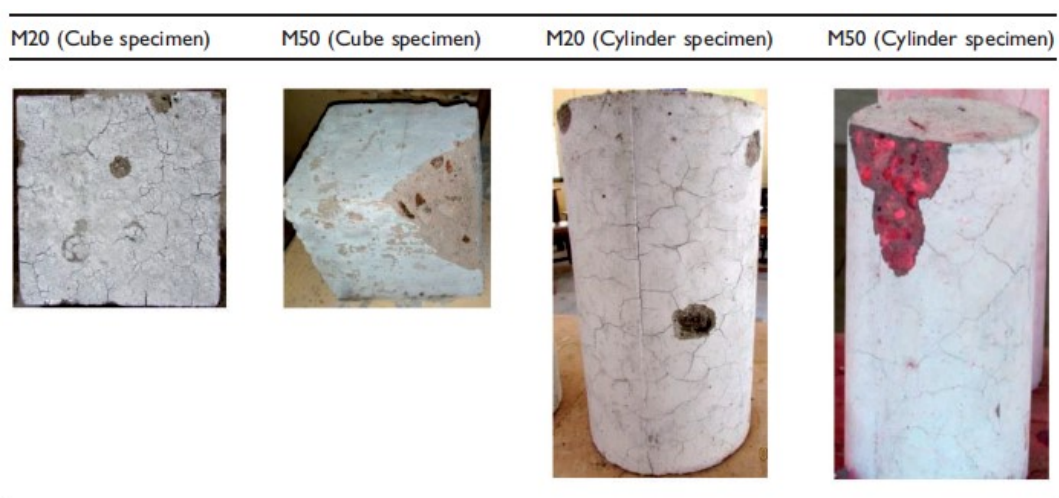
Campioni di calcestruzzo interessati dal fenomeno di spalling (Daniel Paul Thanaraj, N. Anad, G. Prince Arulraj, Ehab Zalok (2019) *Post-fire damage assessment and capacity based modelling of concrete exposed to elevated temperature*).
